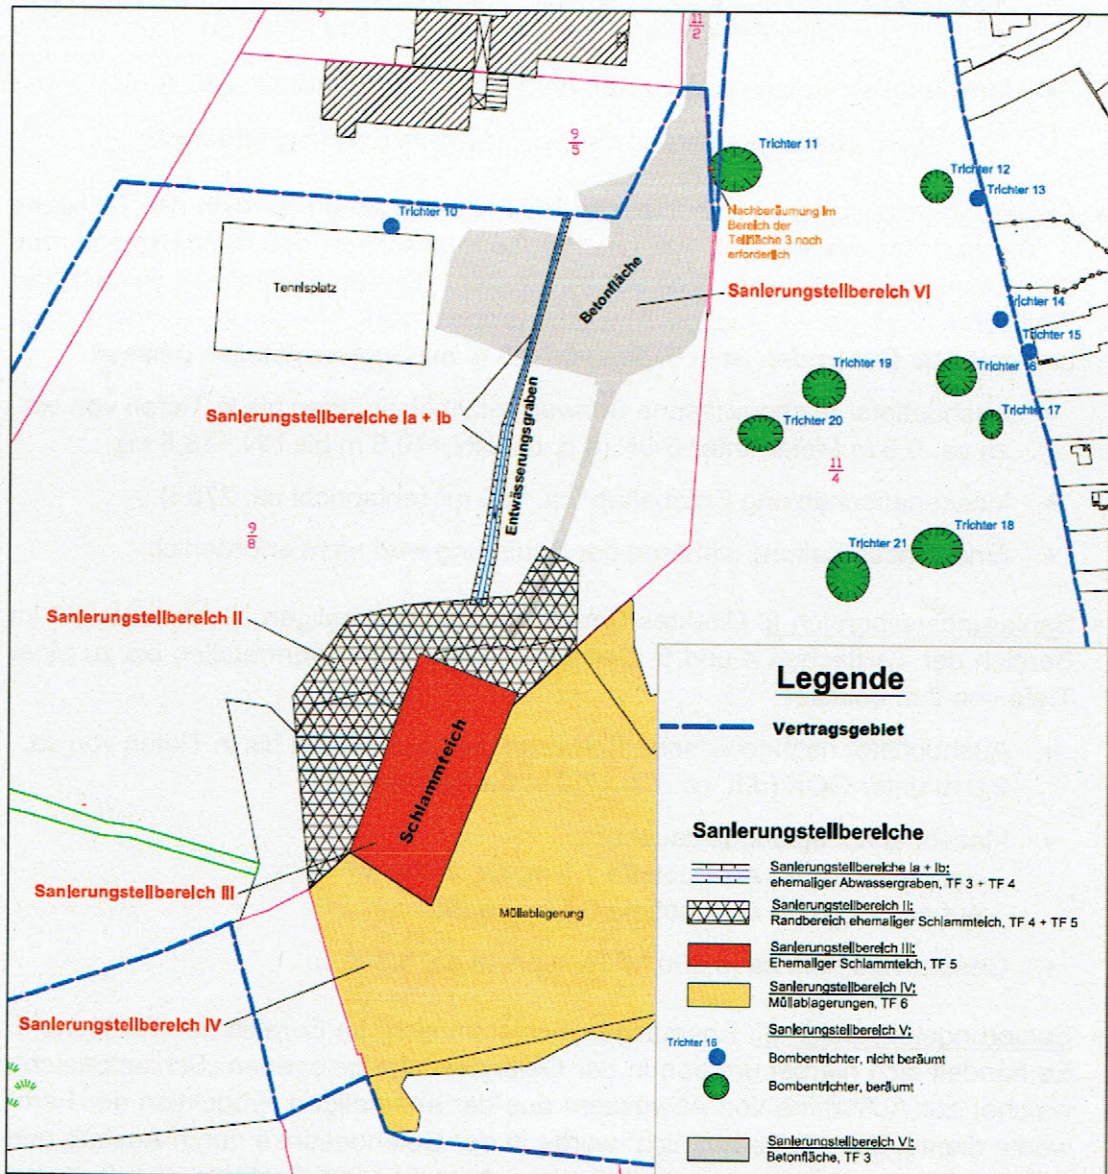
Ausschnitt Lageplan Sanierungsteilbereiche
